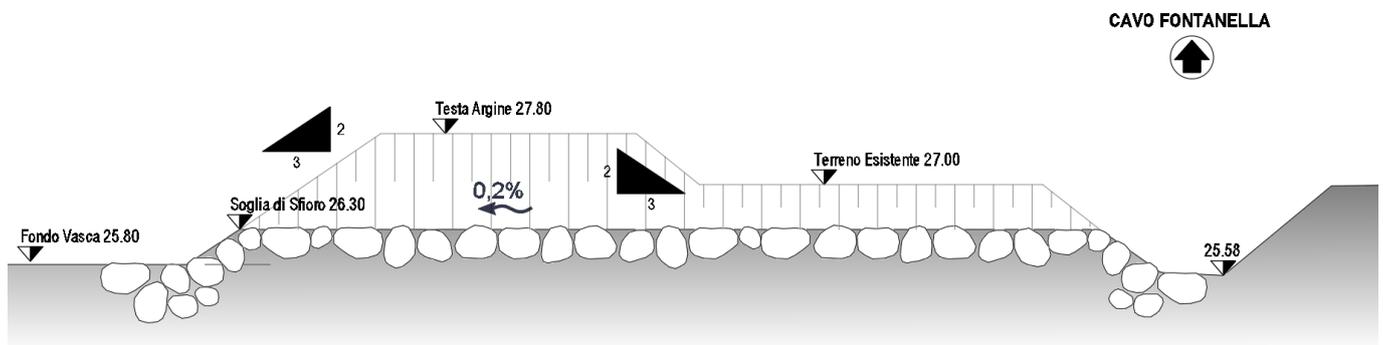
Manufatto di ingresso al bacino di laminazione: sezione trasversale – Cavo Fontanella
